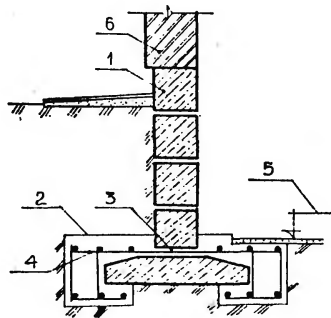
Увеличение опорной площади устройством железобетонной обоймы
